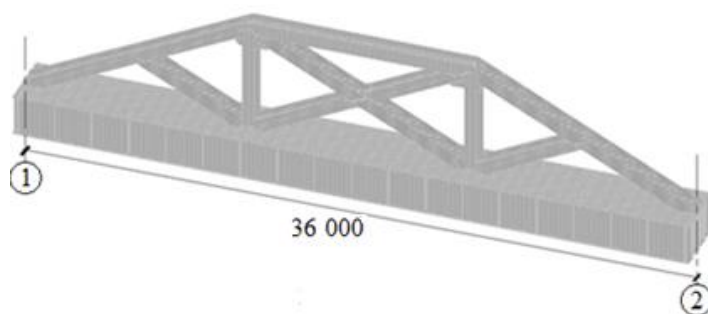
Общий вид расчетной схемы подкраново-подстропильной фермы
